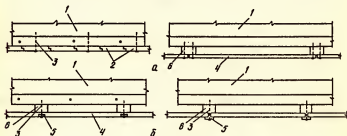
Схемы крепления шпунтованных досок к балкам перекрытия (а) и плит к каркасу из реек (б):
